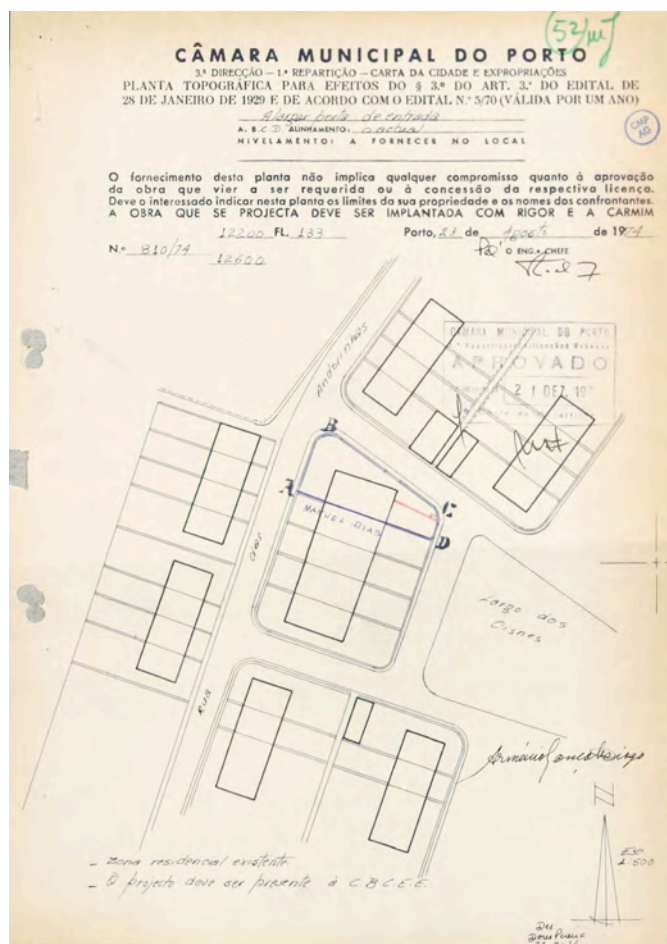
Planta de localização de algumas habitações do Bairro de St. Eugénio
